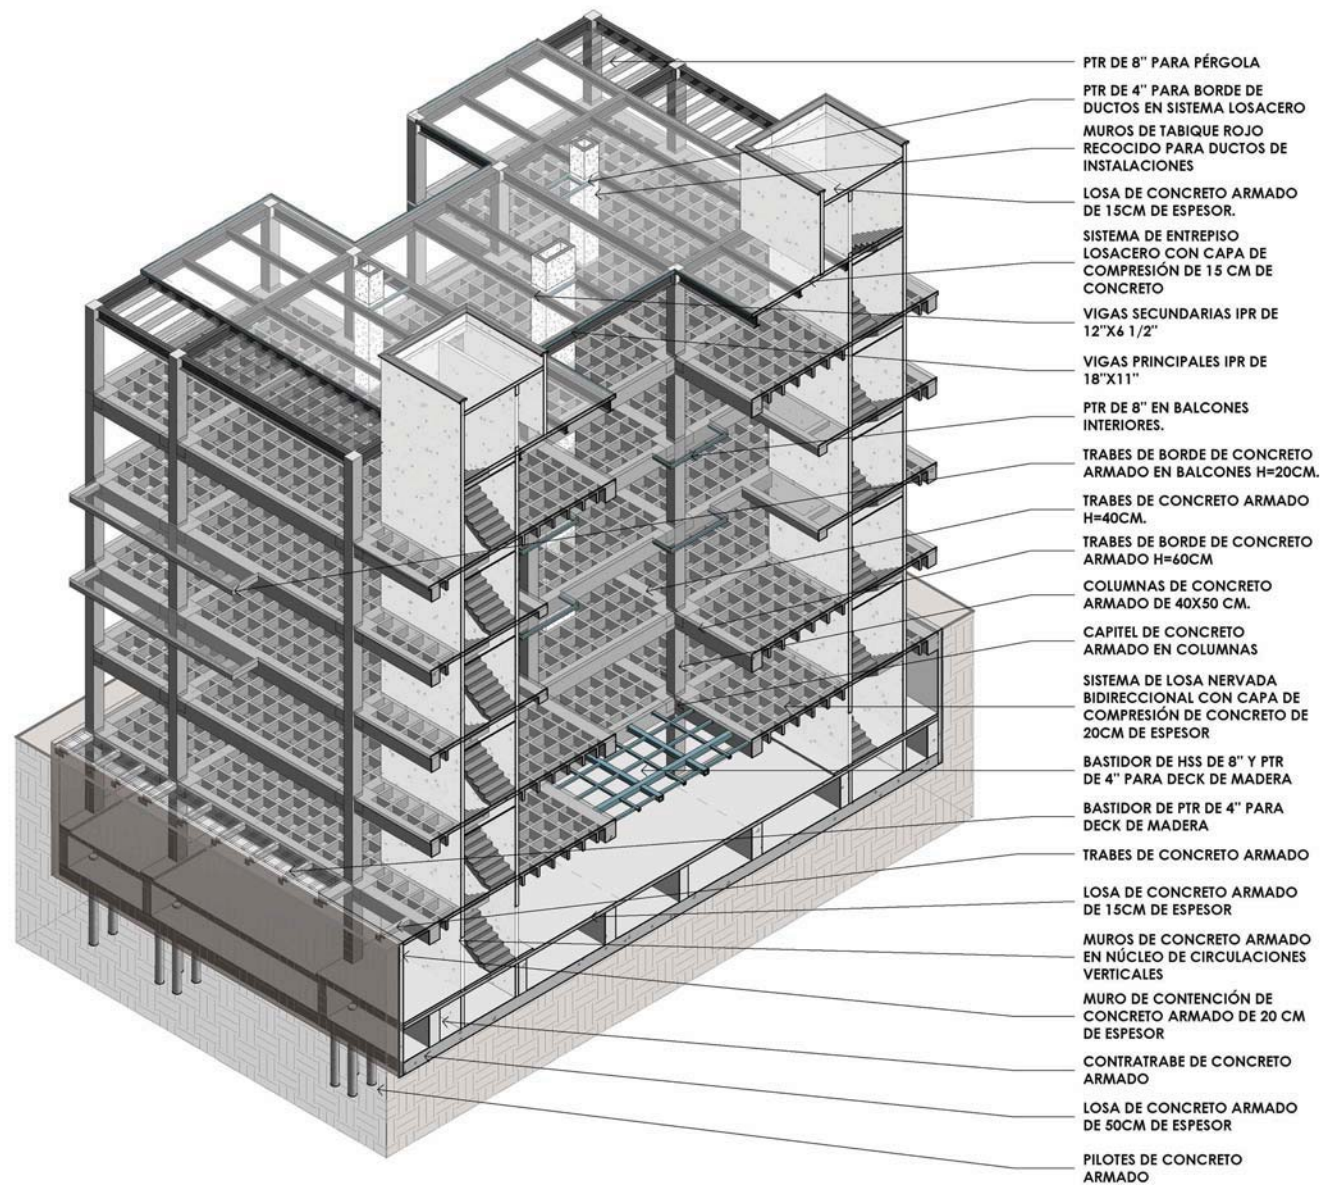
Corte transversal del edificio que muestra el criterio de cimentación y superestructura.
